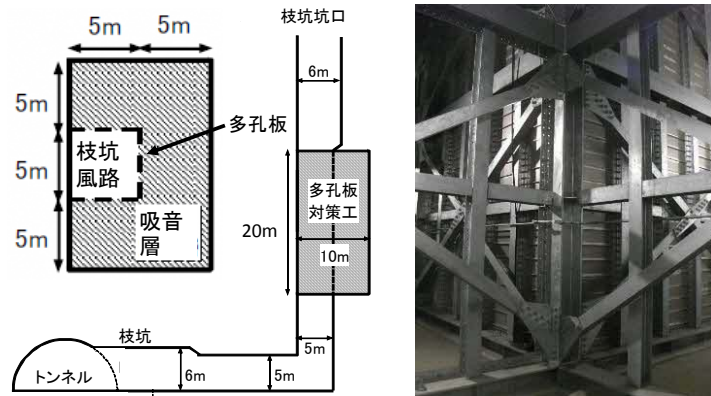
(左) 枝坑の立面図および多孔板対策工の平面図,
